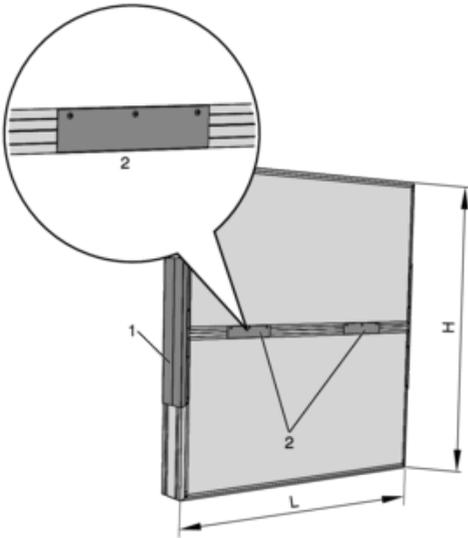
Silencieux à baffle avec subdivision de la hauteur
